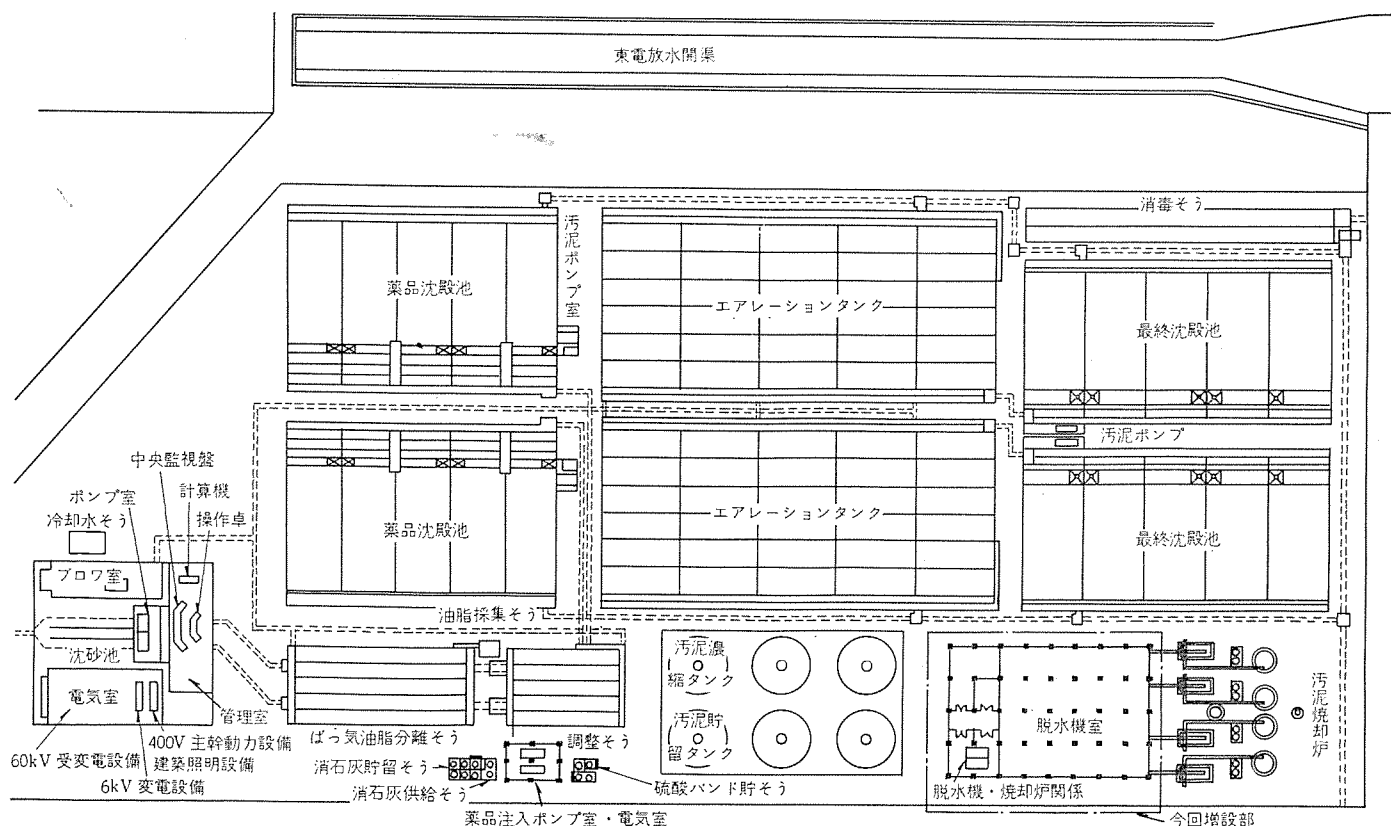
深芝処理場平面図 General plan of Fukushima sewage treatment plant.
